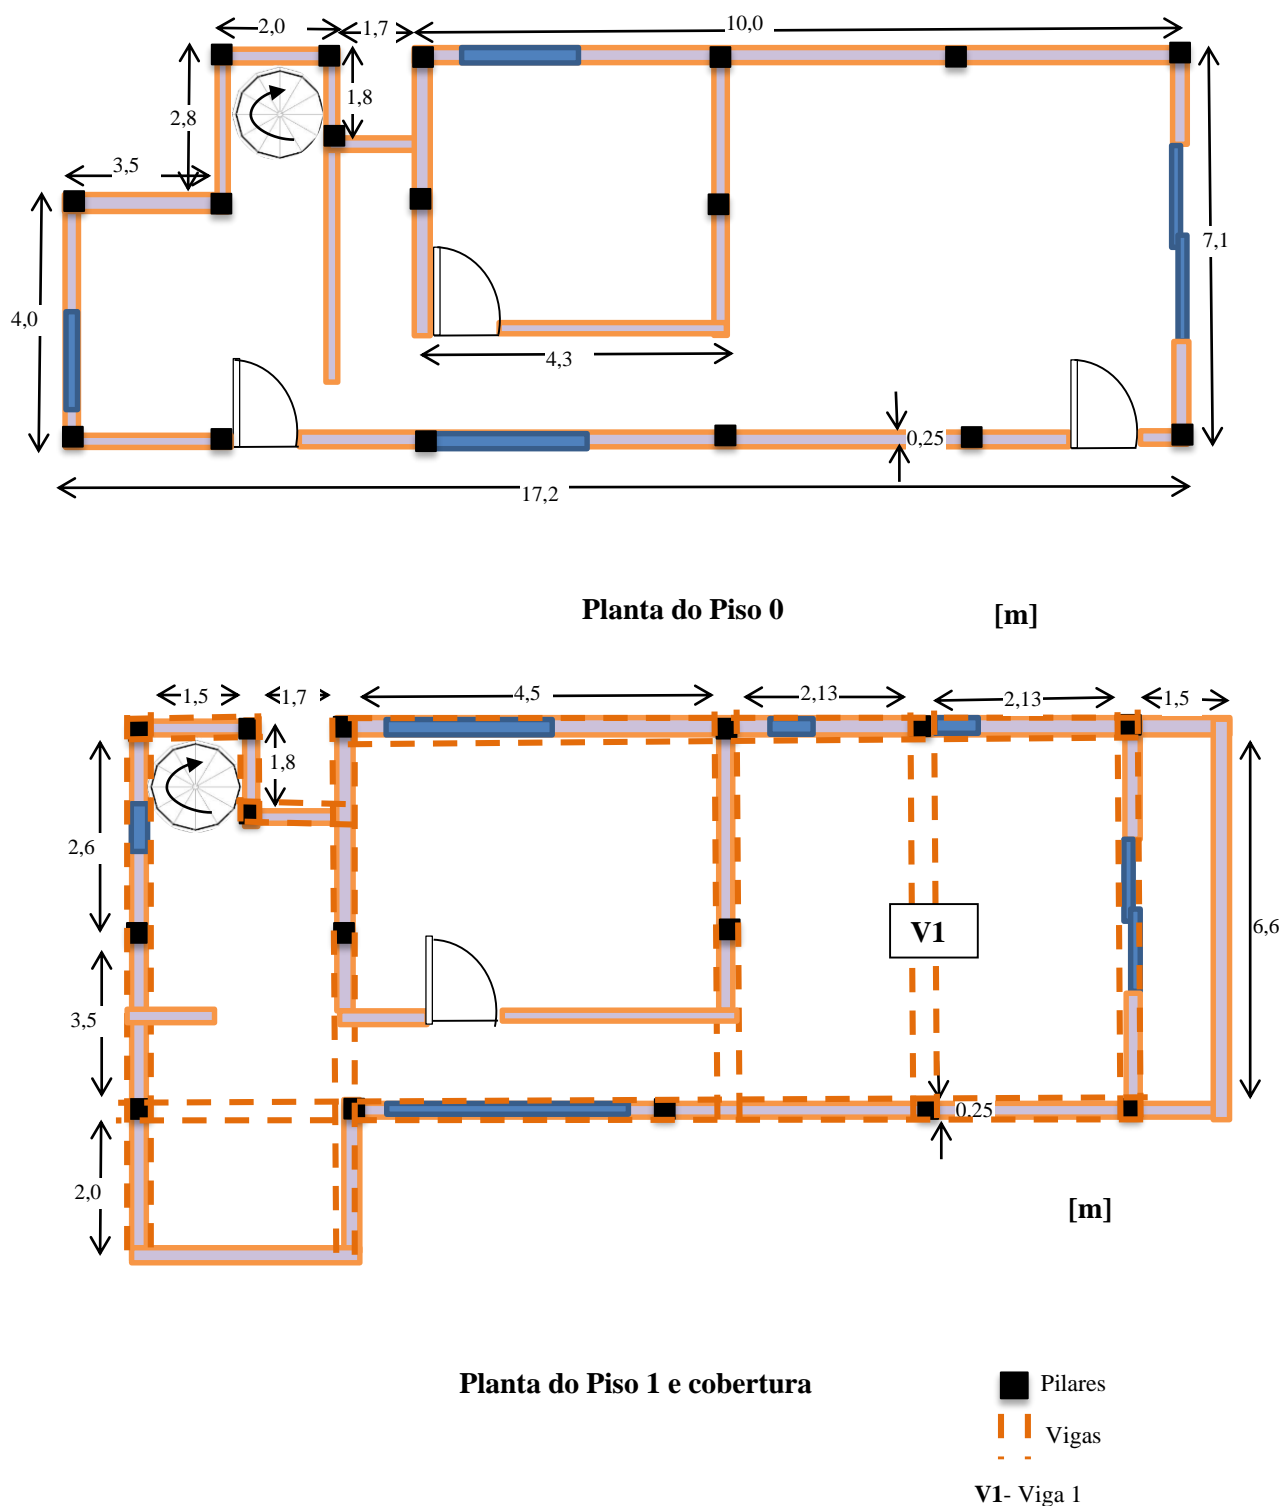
Esboço da disposição dos pilares e vigas que foram adotadas na análise orçamental da solução corrente de alvenaria e B.A. para a obra de Palmela
